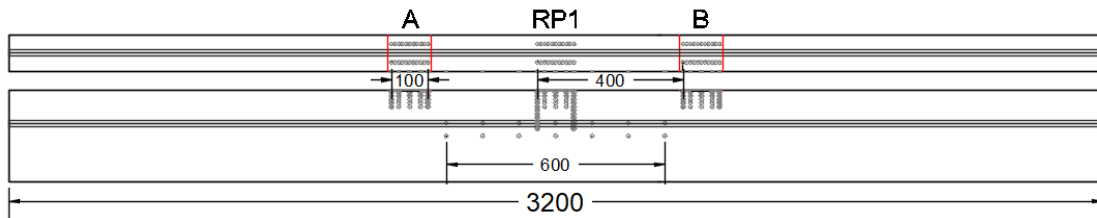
Vista en planta (parte superior) y alzado (parte inferior) del espécimen a ensayar. (Fuente: Elaboración Propia)
